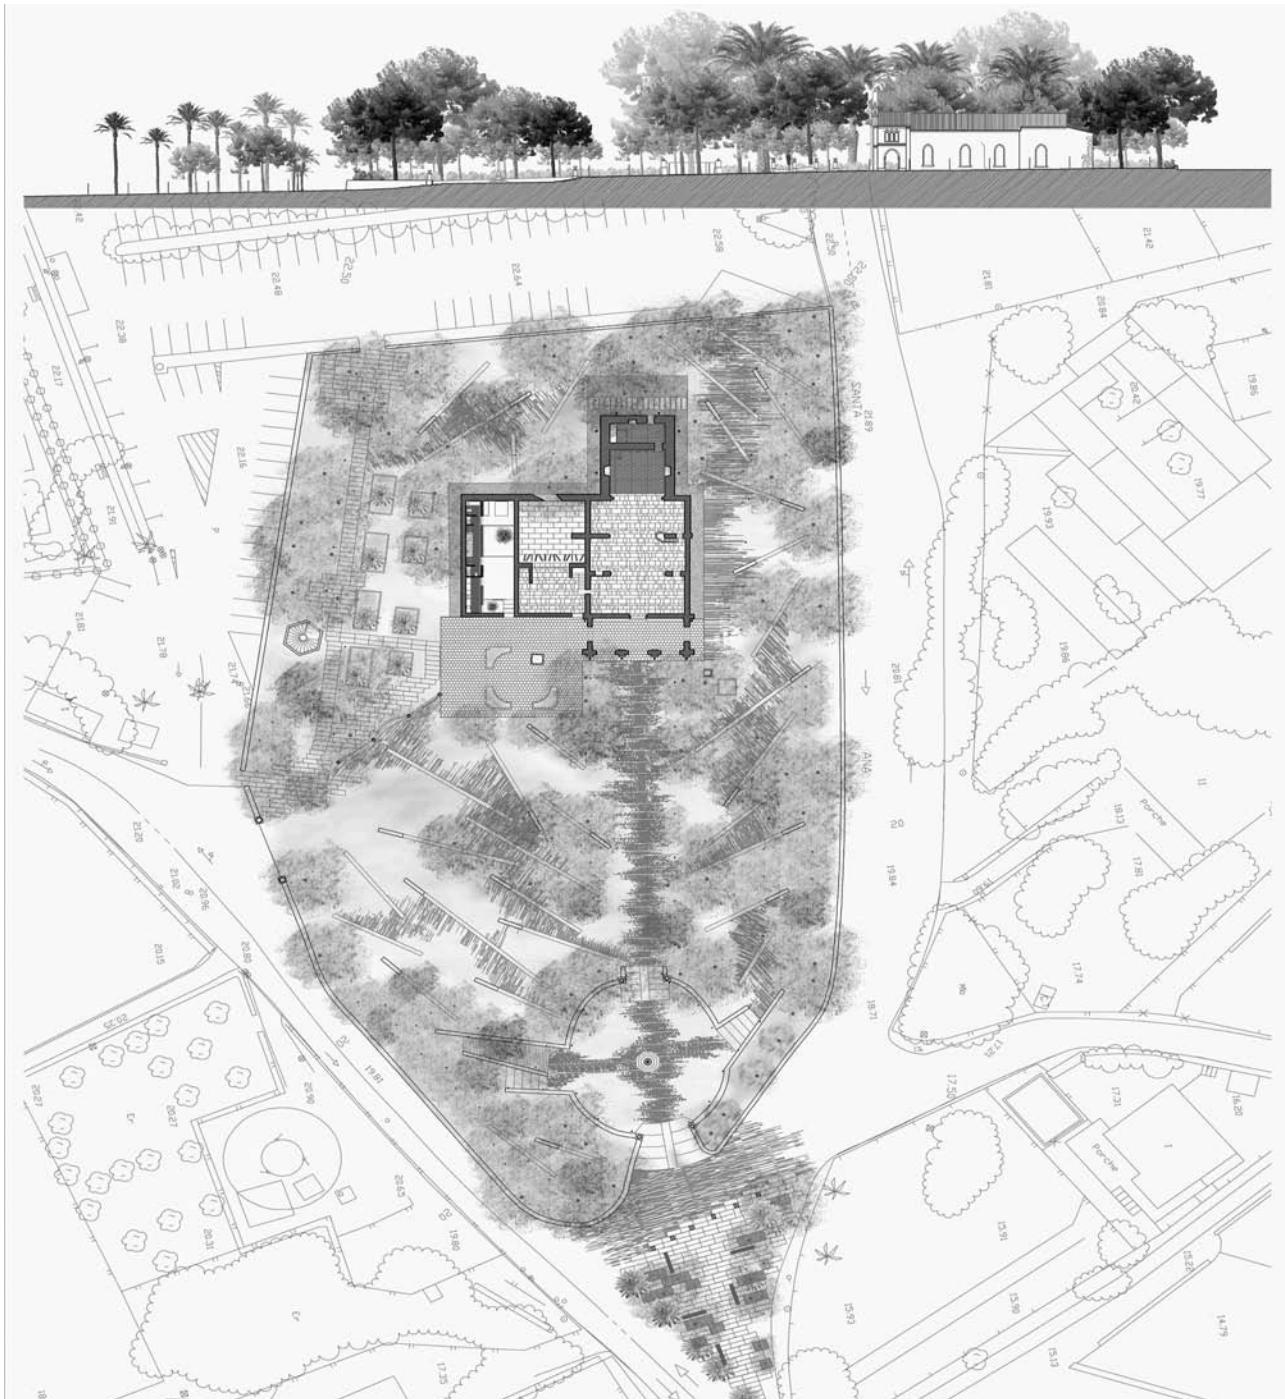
Planta general de la intervención: parque y ermita de Santa Anna
